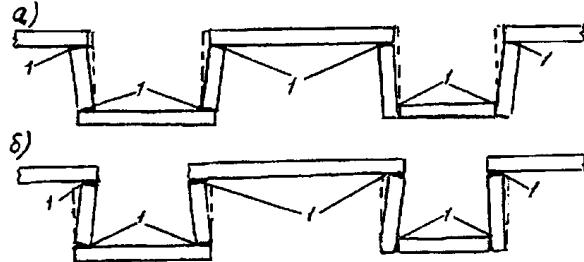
Схема возможной деформации стен при наличии выступов (ризалитов) в зданиях (а — при охлаждении стены; б — при нагреве стены):
